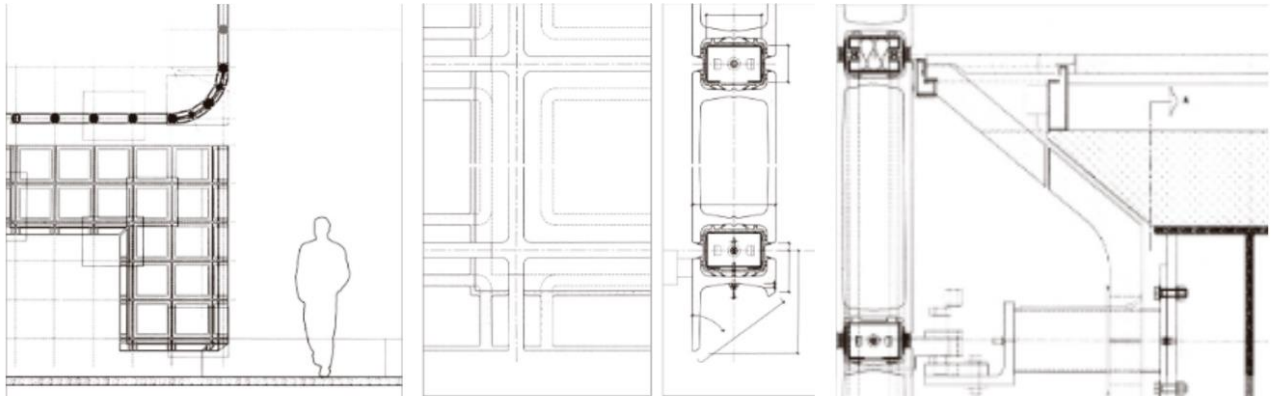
Detalle constructivo de piel, Maison Hermes, Tokio. Fuente: Arquitectura Viva
